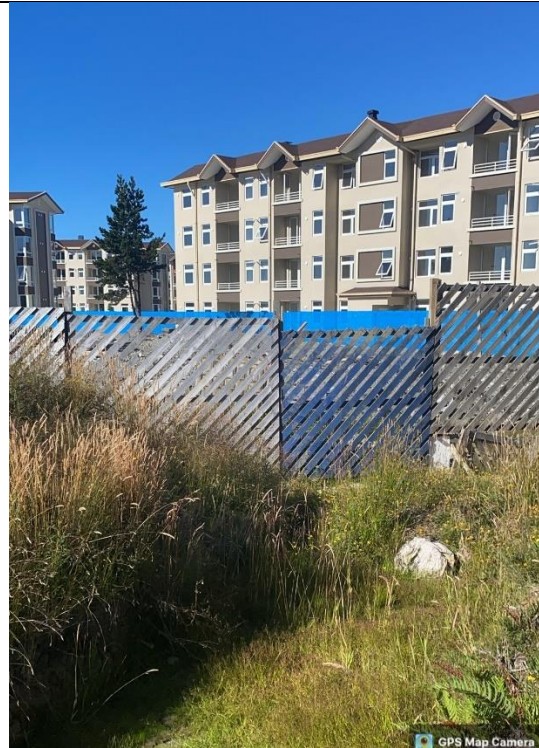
zanjas ejecutadas en lote 3-c que provienen desde el interior del proyecto
